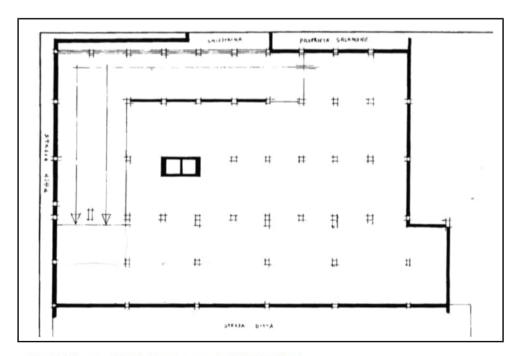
Estratto della planimetria catastale del 19/12/1984
